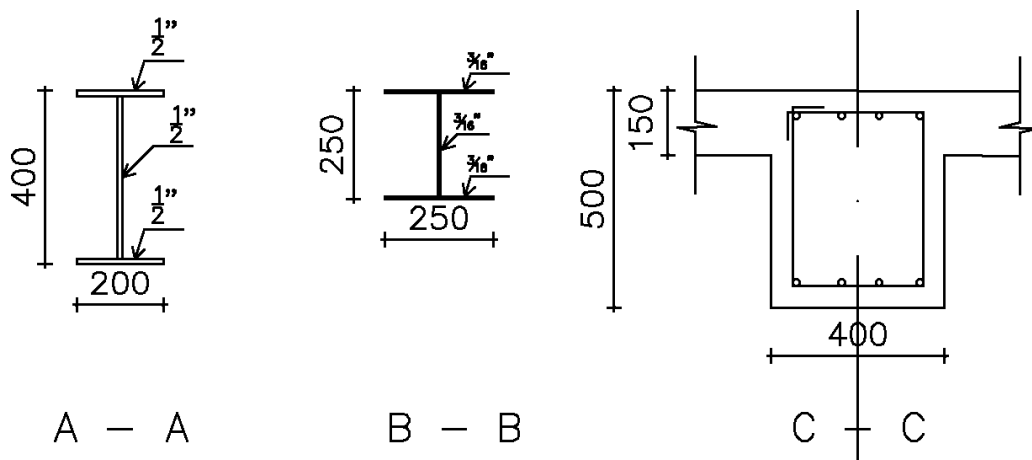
Esquema y cortes, Pórtico de carga y Viga de fundación
